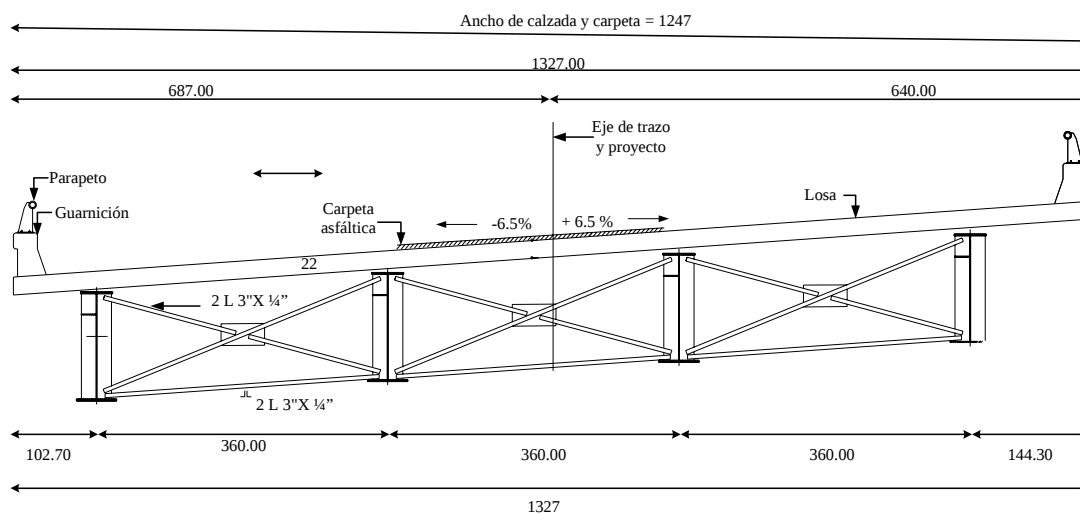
Sección transversal de la superestructura entre el apoyo 2 y 3
